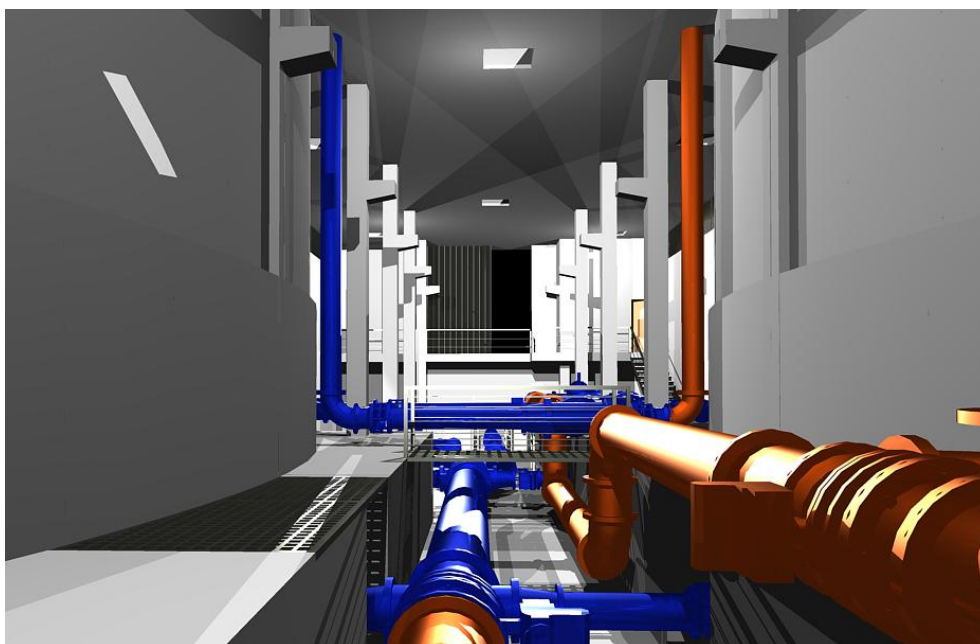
Vista 3D do interior da Câmara de Manobras
